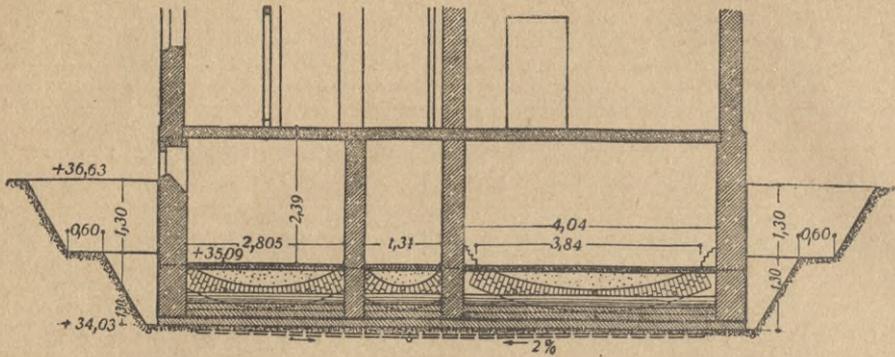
Gründung eines freistehenden Wohnhauses (siehe Anhang) auf Grundgewölbe. [Berechnungsbeispiel 1.]
